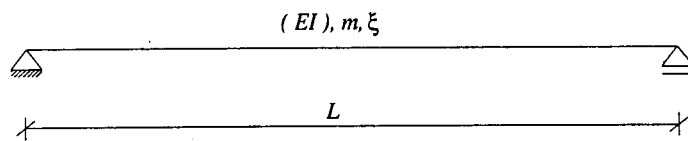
Viga simplesmente apoiada utilizada como modelo do meio tabuleiro
